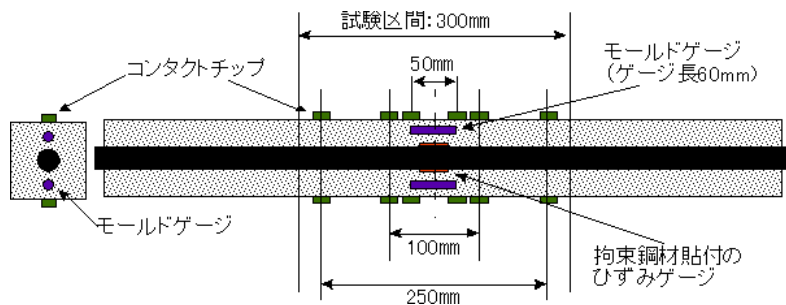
コンクリートと拘束鋼材のひずみ適合性の検討概要
